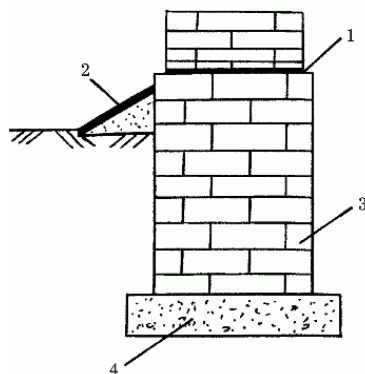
Общий вид кирпичного ленточного фундамента: 1 – горизонтальная гидроизоляция; 2 – отмостка; 3 – кирпичная кладка; 4 – монолитная фундаментная плита
